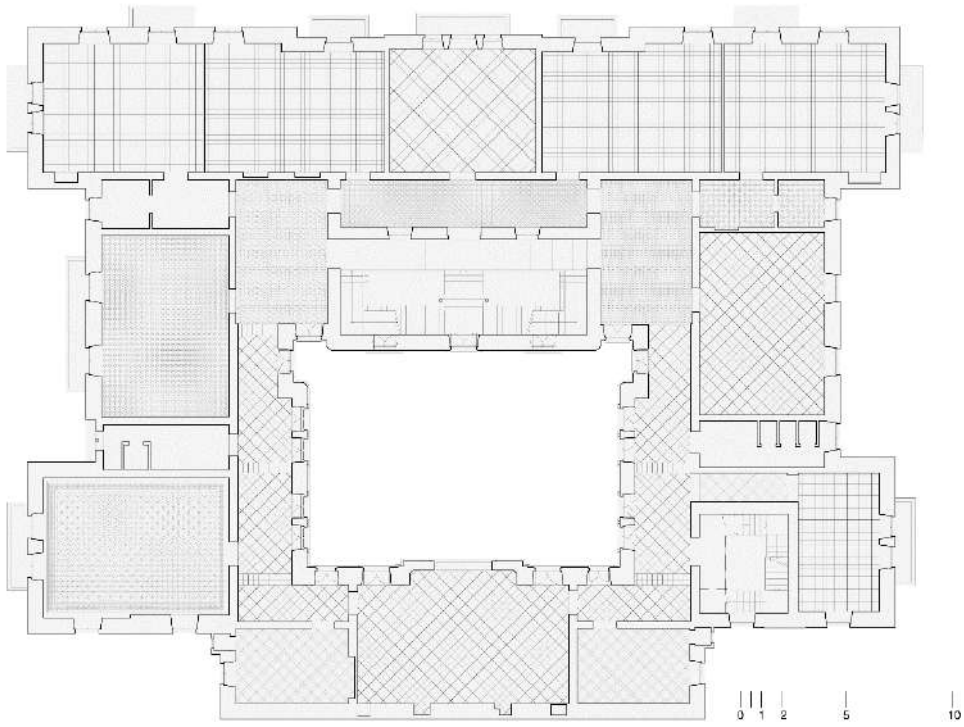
| Pianta del secondo piano dell'ex Istituto Nautico F. Caracciolo, Bari: disegno di rilievo delle pavimentazioni.
